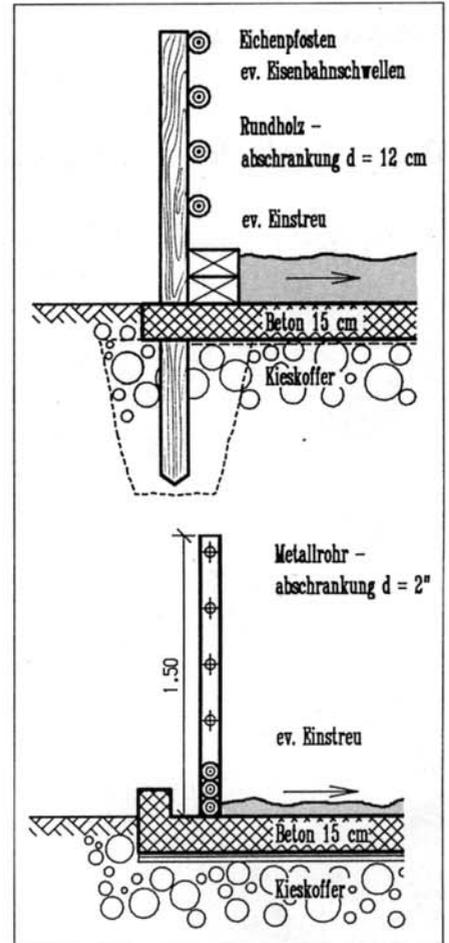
Übergang Bodenplatte/ Einzäunung. Zaun aus Rundholz und Stahlrohren
